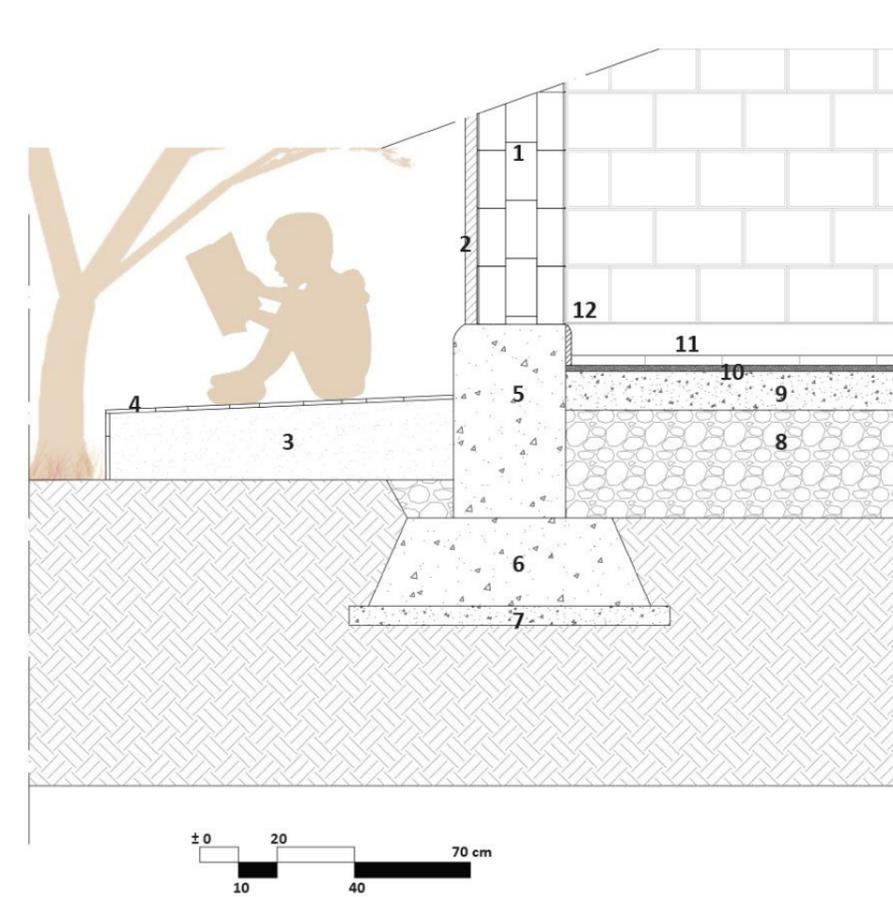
Sezione della fondazione con basamento e pavimento in terra stabilizzata. (Elaborazione propria).
